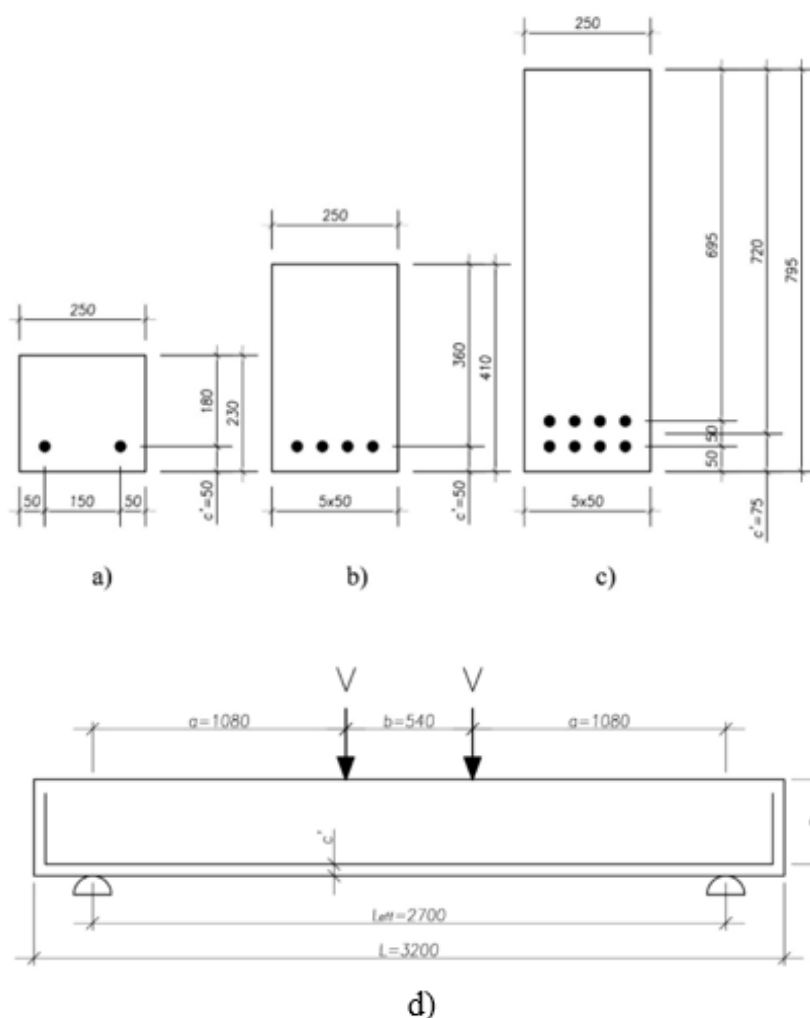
(a,b,c) Secciones transversales de las tres vigas de estudio. d) Esquema de la geometría de la viga reforzada longitudinalmente [29]
